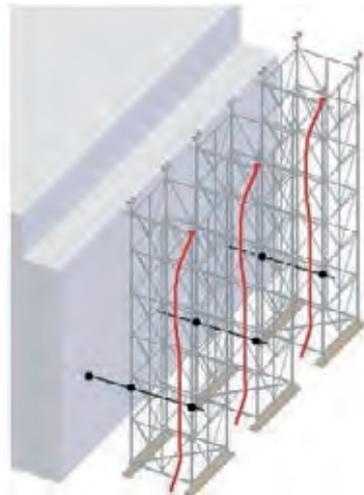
Líneas de vida verticales y anclajes a la estructura existente
